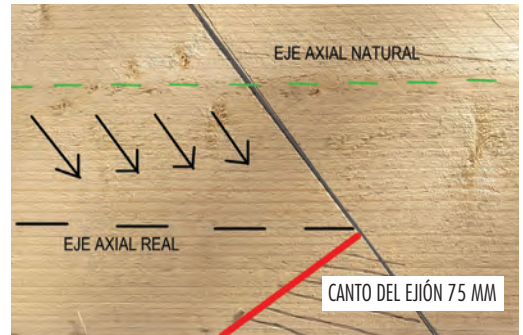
Eje axial real de la tornapunta. Fuente: Autor.
